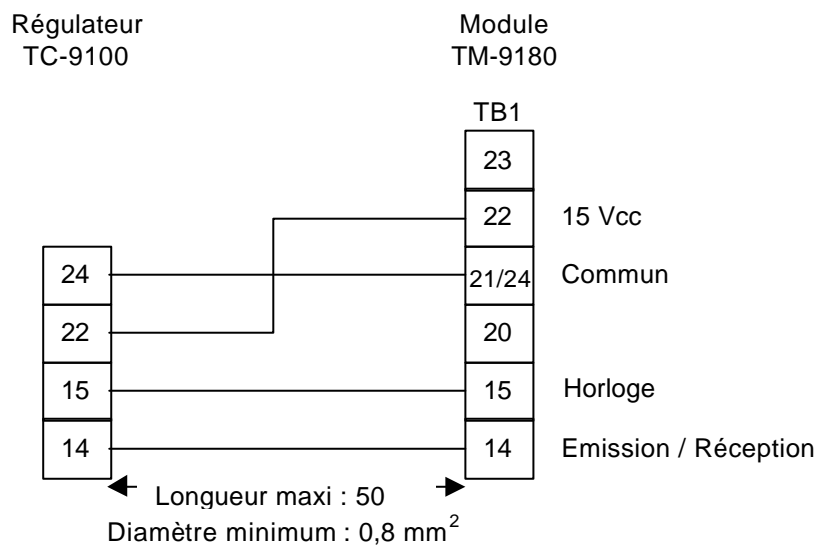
Câblage du module TM-9180 sur un régulateur universel TC-9100
